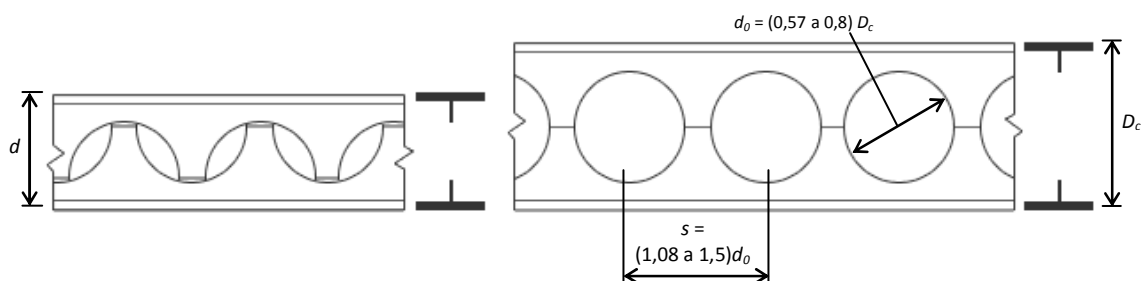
Geometria para fabricação das vigas celulares
